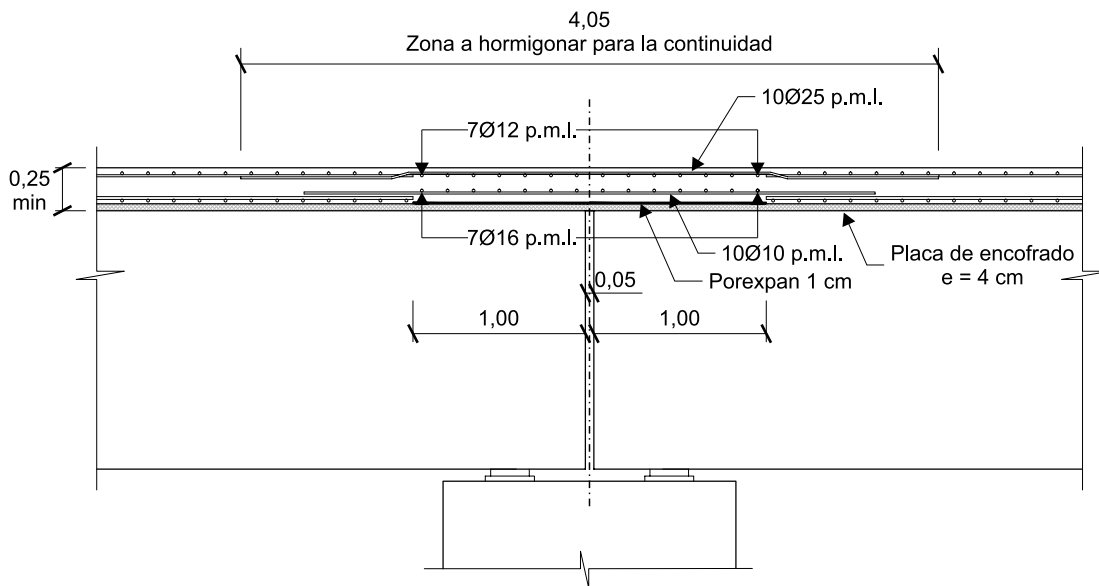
Detalle de losa de continuidad entre vanos isostáticos de un puente de vigas prefabricadas
